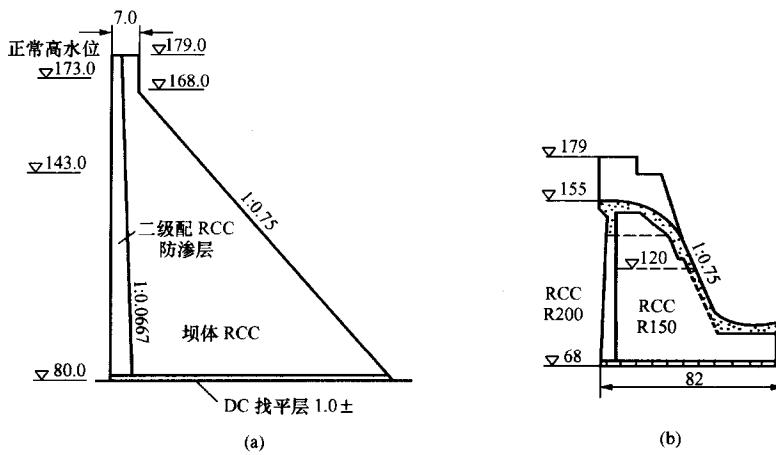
棉花滩碾压混凝土重力坝剖面图 (单位: m)
